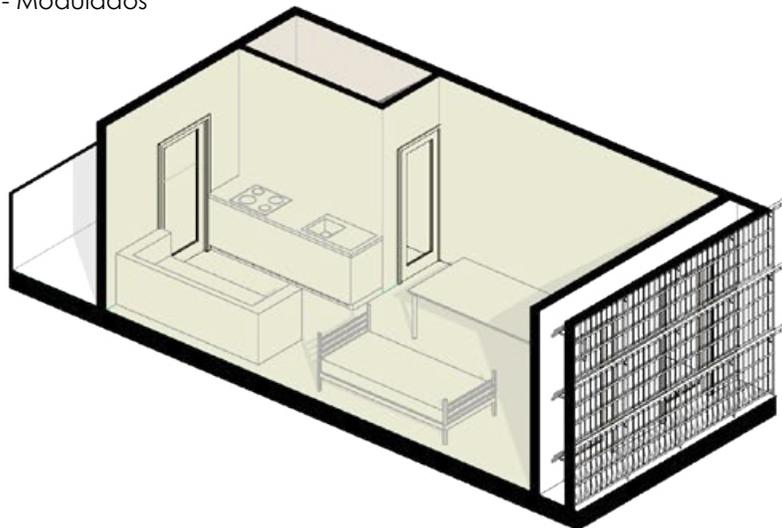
Planta Arquitectónica. Fuente: Ovacen, 2018
